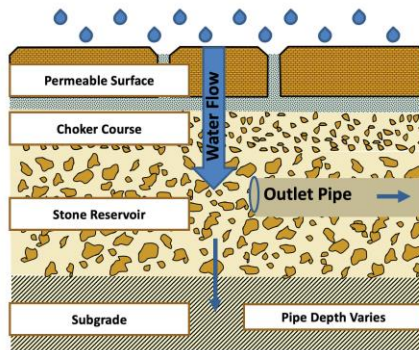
Ilustrasi Infiltrasi Secara Penuh *Permeable Pavement
